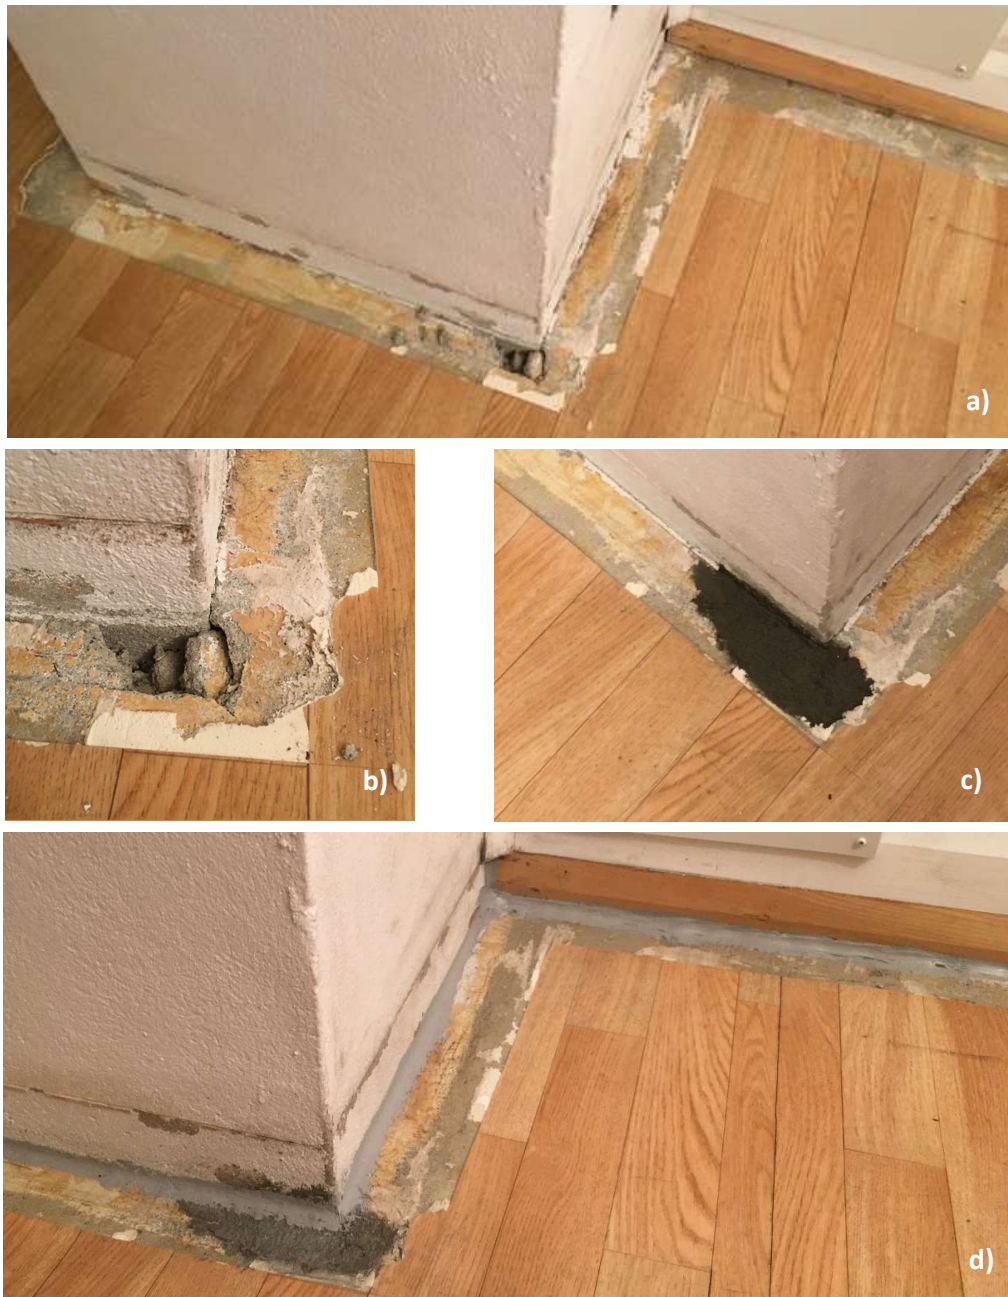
Tetting rundt dør. Plassering vist på tegning i figur 4.3.2-1, a) belegg revet av; b) meislet; c) fuget.
